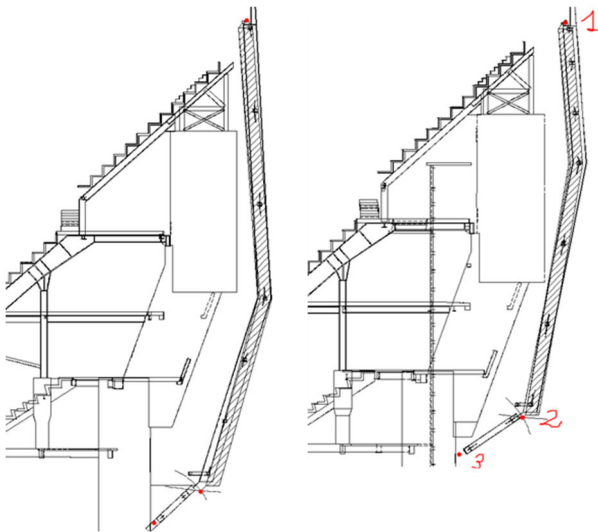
Fachada: Esquema de desplazamientos y giros en costillas y puntales de fachadas N-S
